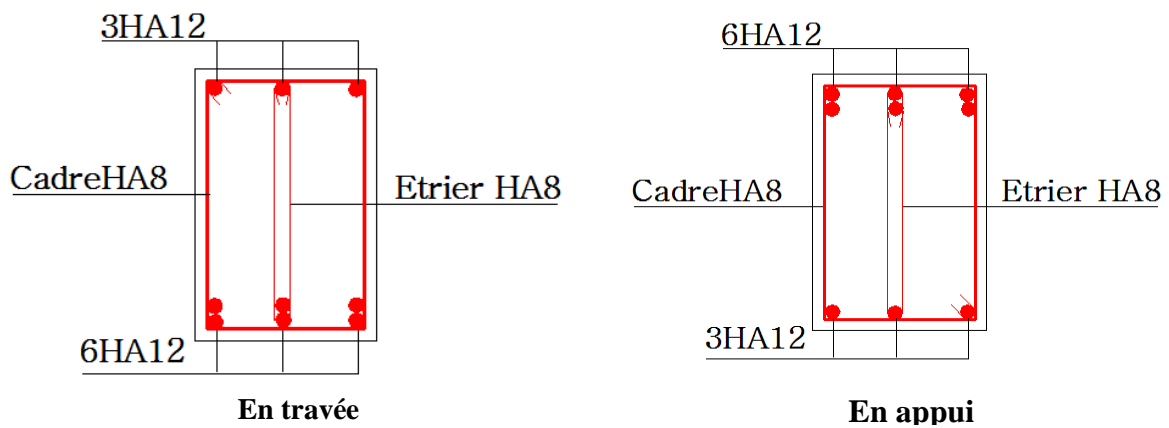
Schémas de ferrailage des poutres principales de la terrasse.
